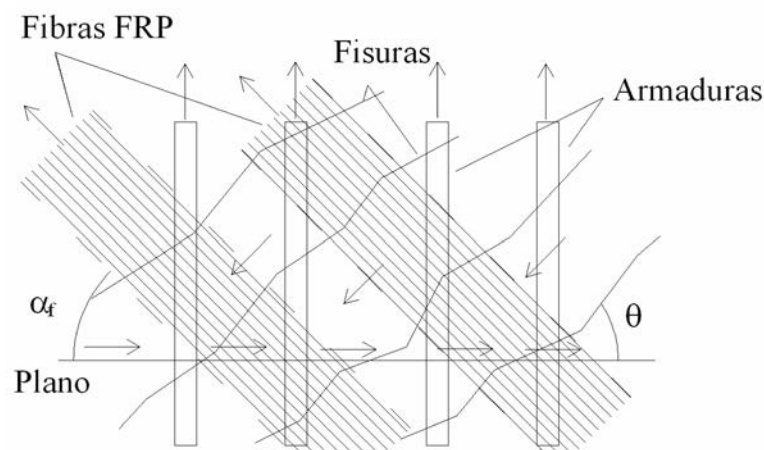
Representación del estado de tensiones para una sección de hormigón fisurada.
